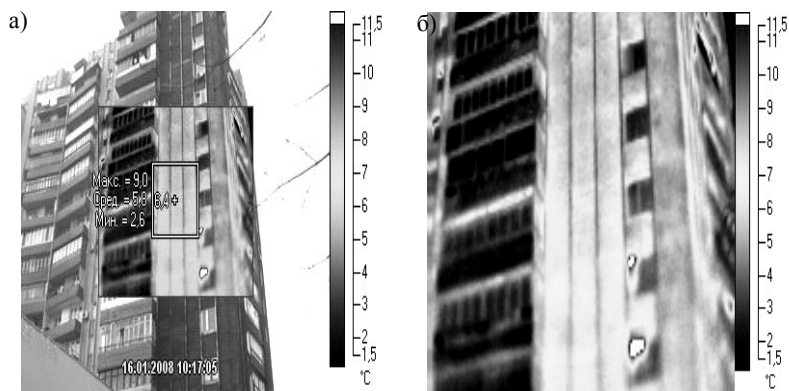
Утепление стен фасада монолитного здания пенополиуретаном
